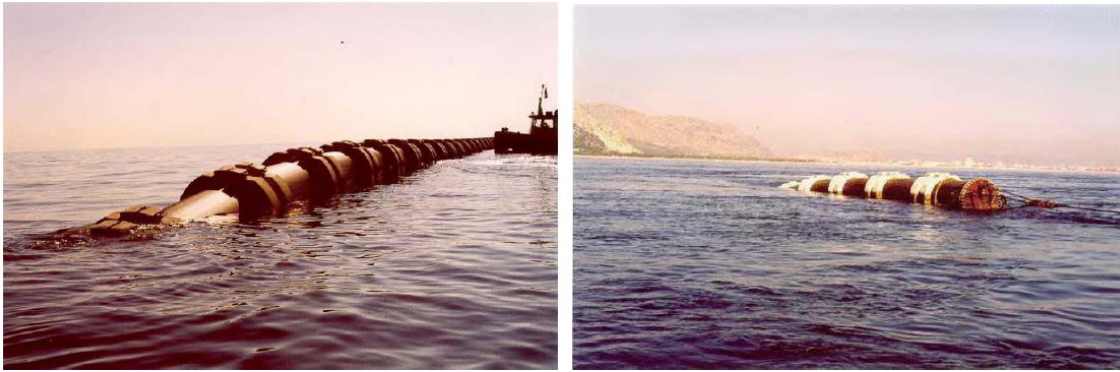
Initialisation (à gauche) et finalisation (à droite) de l'installation de la section de conduite.
